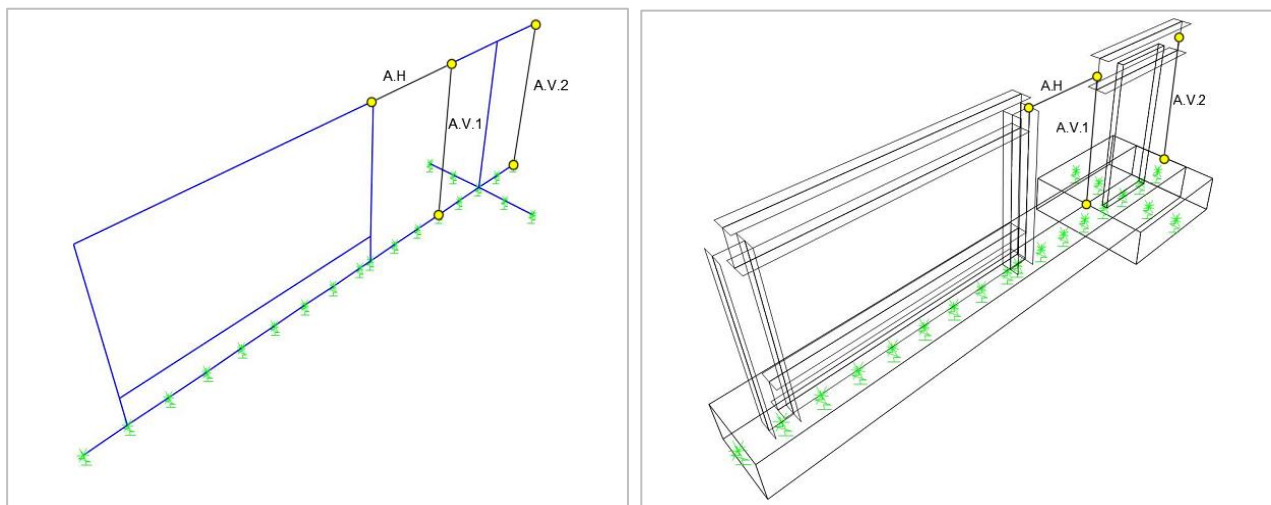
Sistema con viga de carga sobre el eje del espécimen: A) Vista normal elementos; B) Vista extruida elementos
